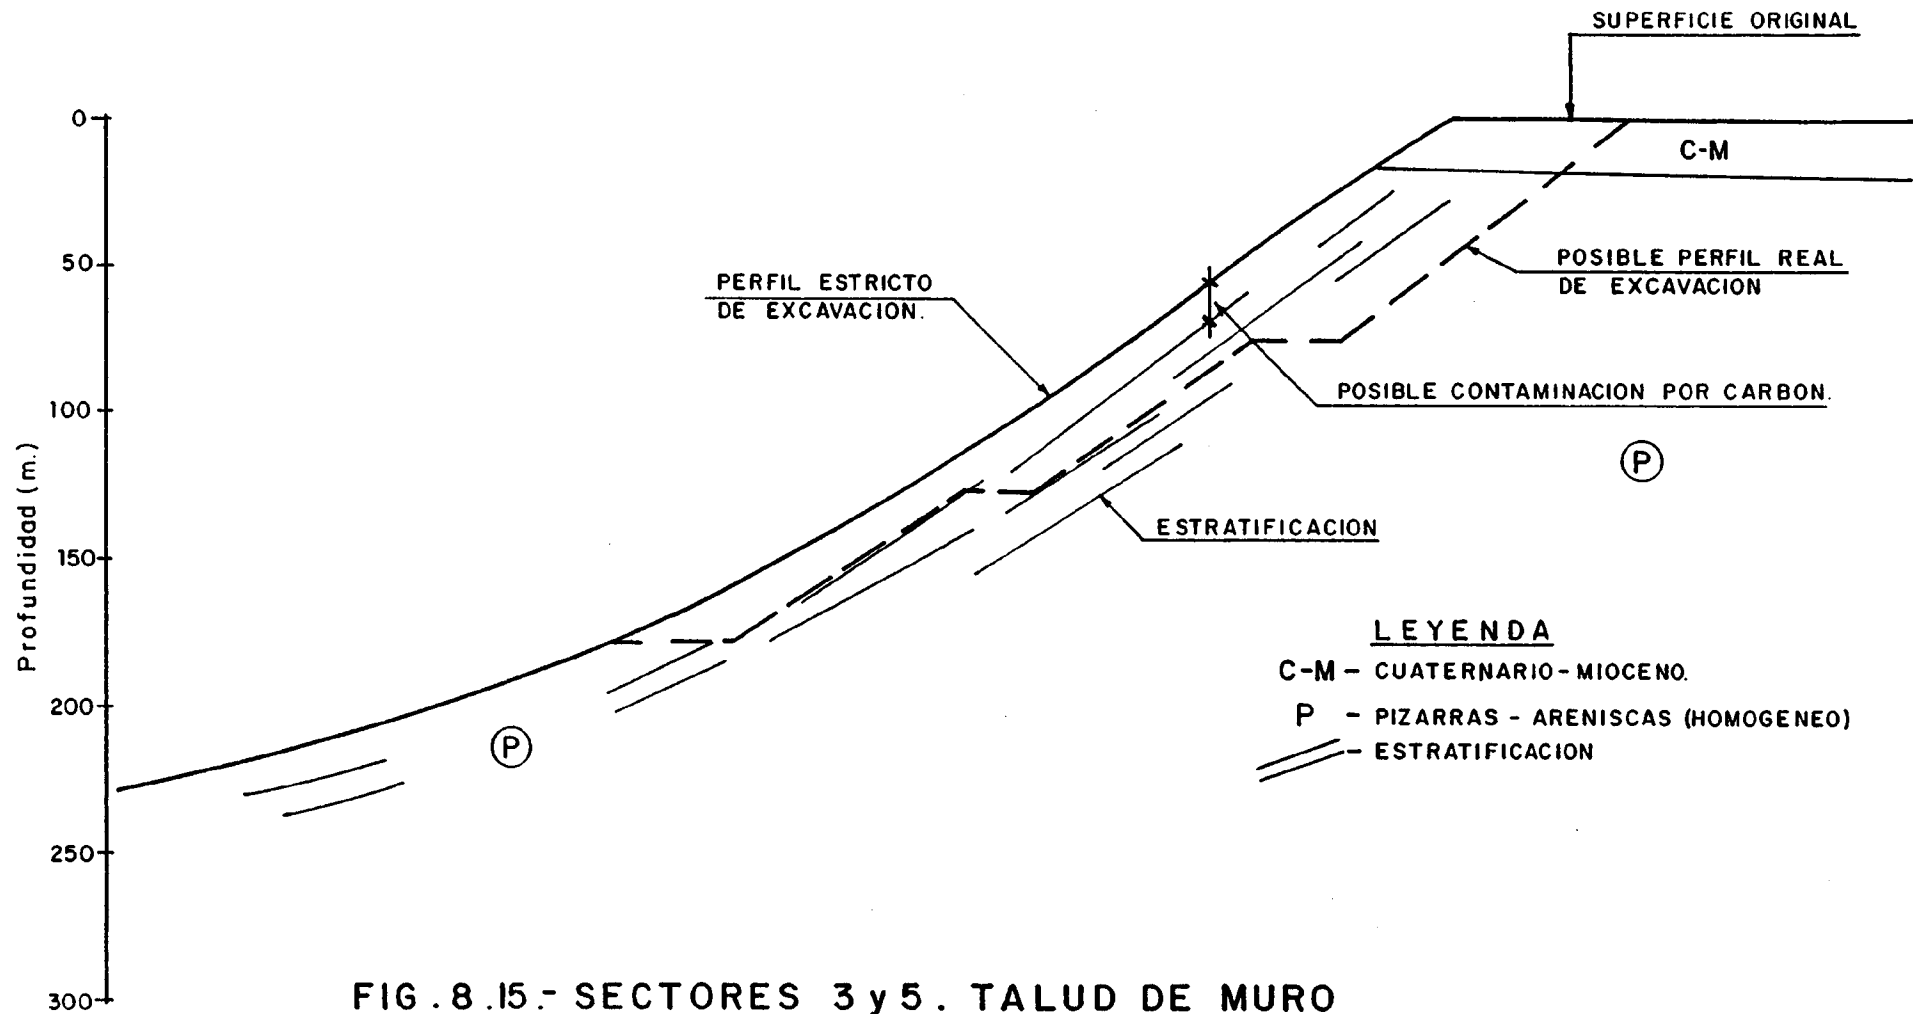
SECTORES 3 y 5. TALUD DE MURO
